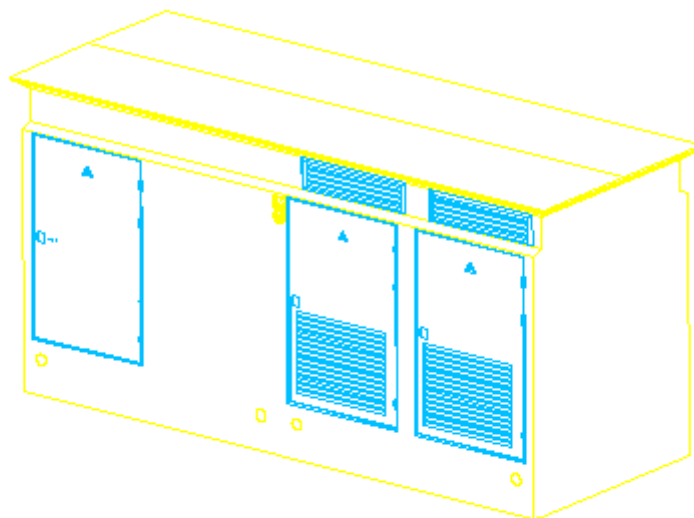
Alzado y Planta Nuevo Edificio prefabricado. Centro de Transformación
